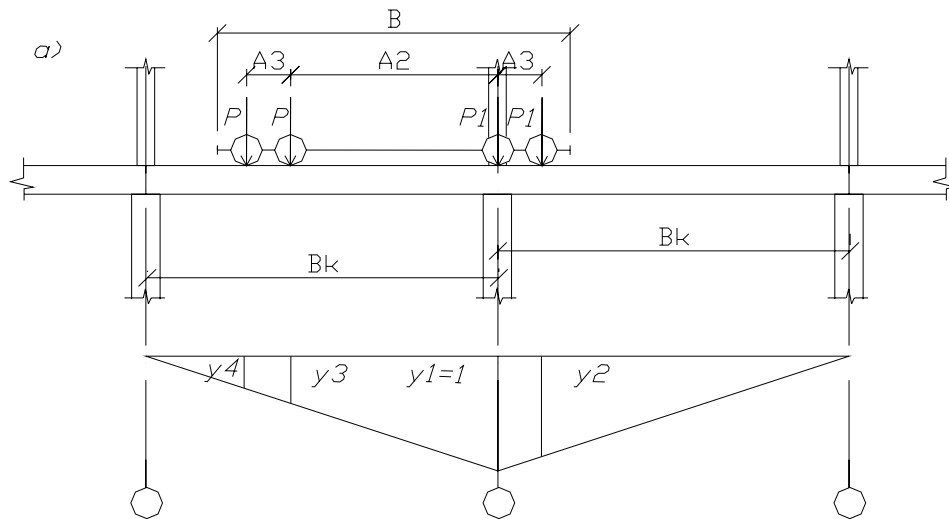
К определению нагрузок на раму от мостовых опорных кранов
